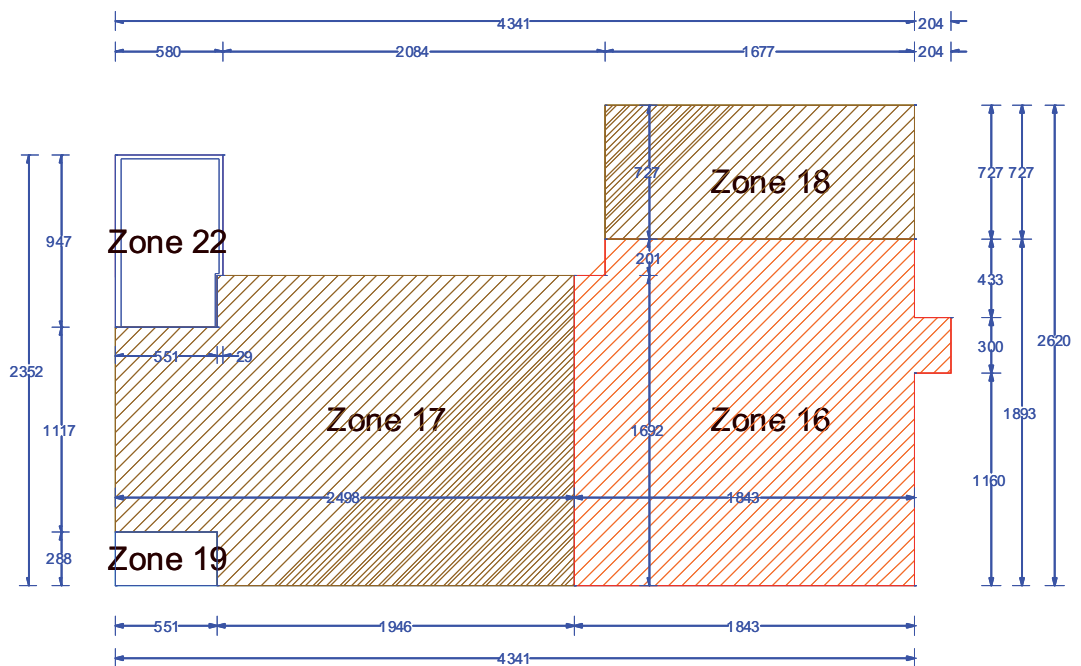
Dachgeschoss: Thermische Zonen und Außenabmessungen
